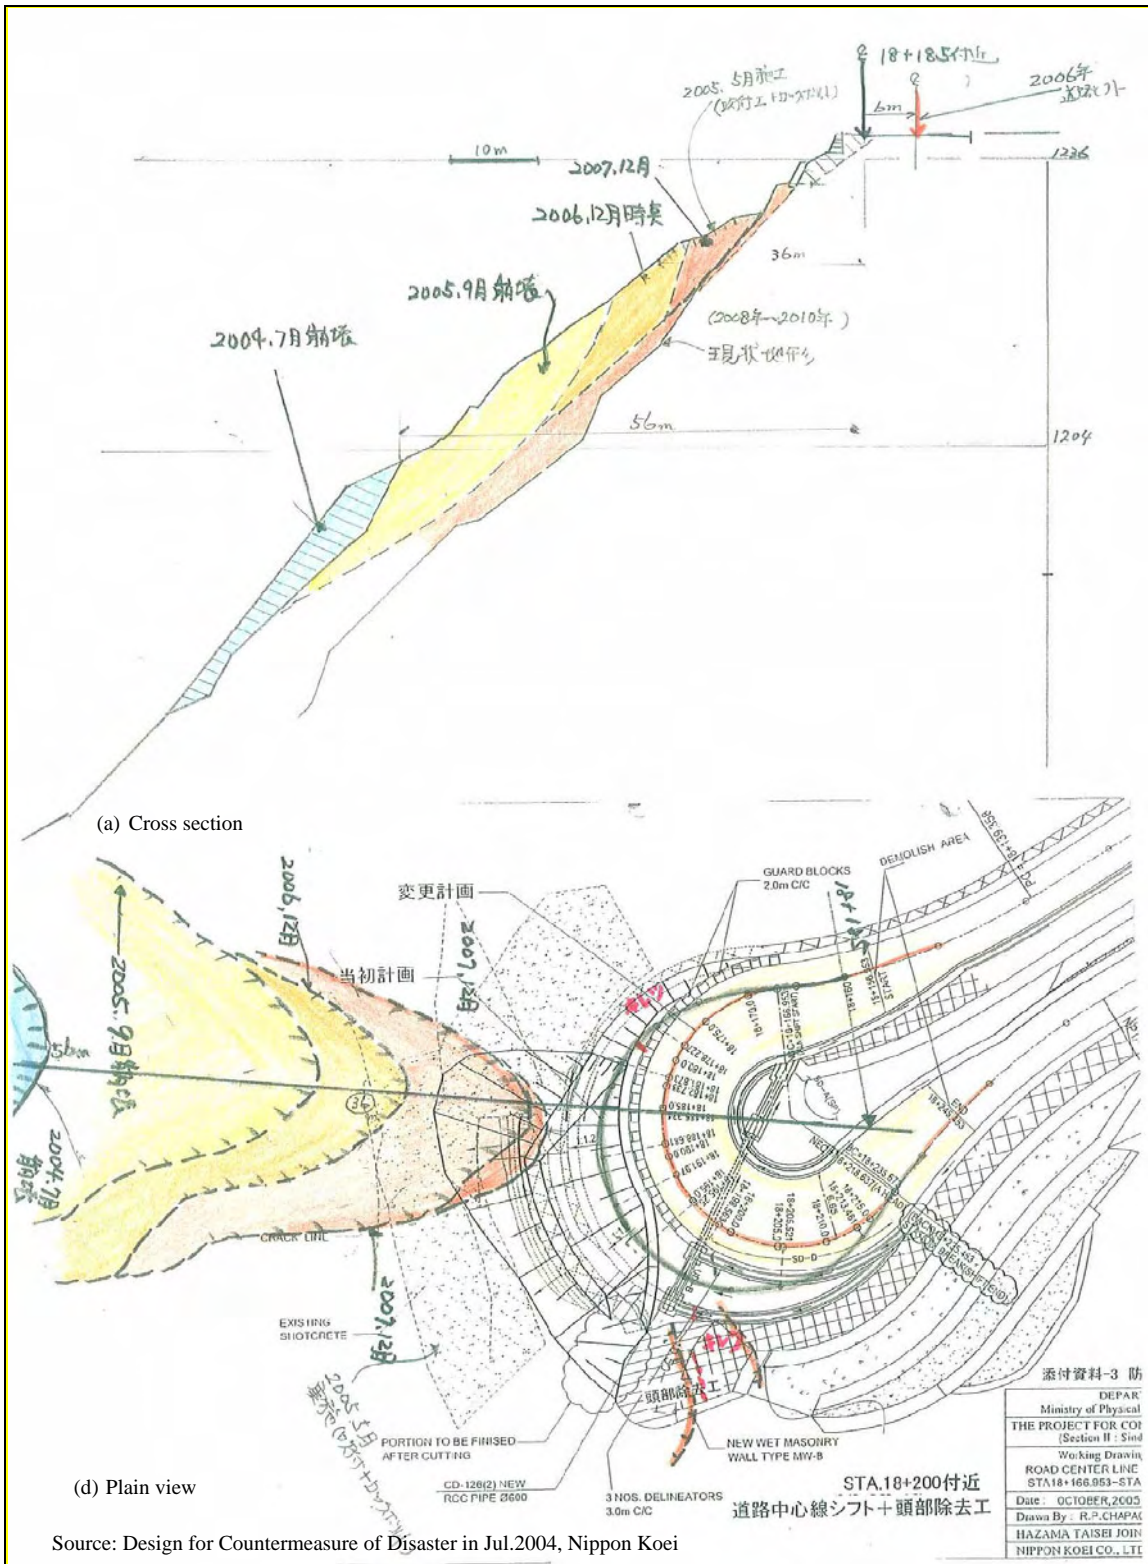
Sta.18+200 の斜面崩壊履歴の模式平面図及び断面図
